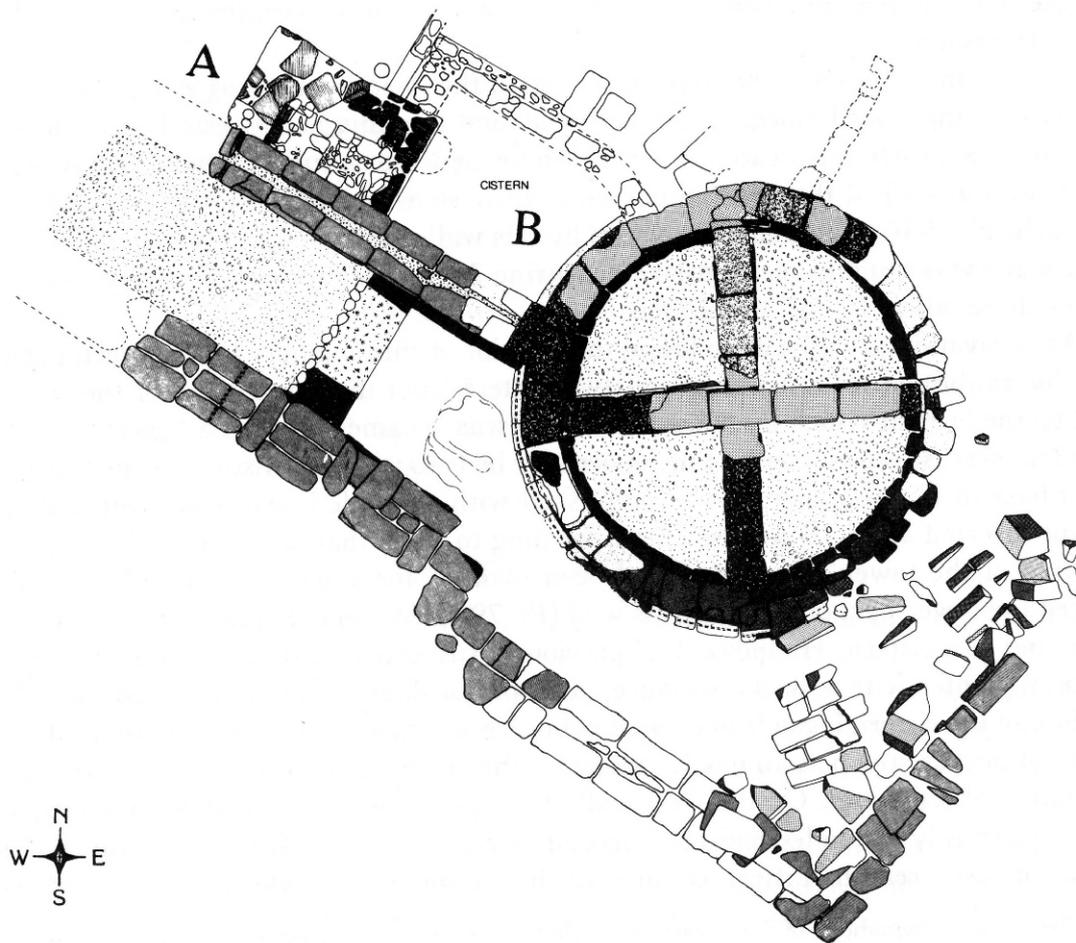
Grundriss des Rundturms von Phalasarna
